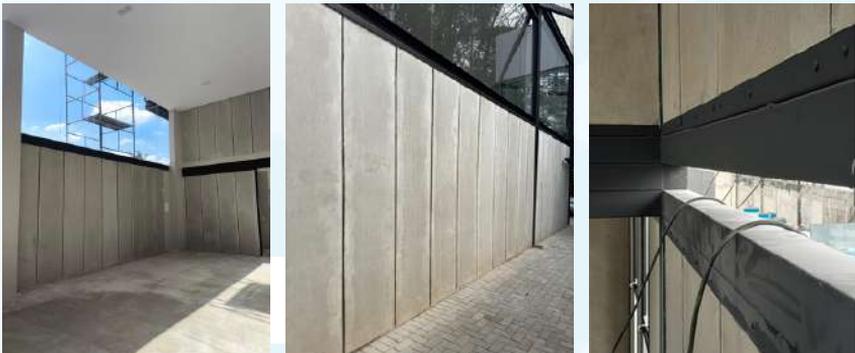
exemplos da utilização de cantoneiras e vigas intermediárias.
